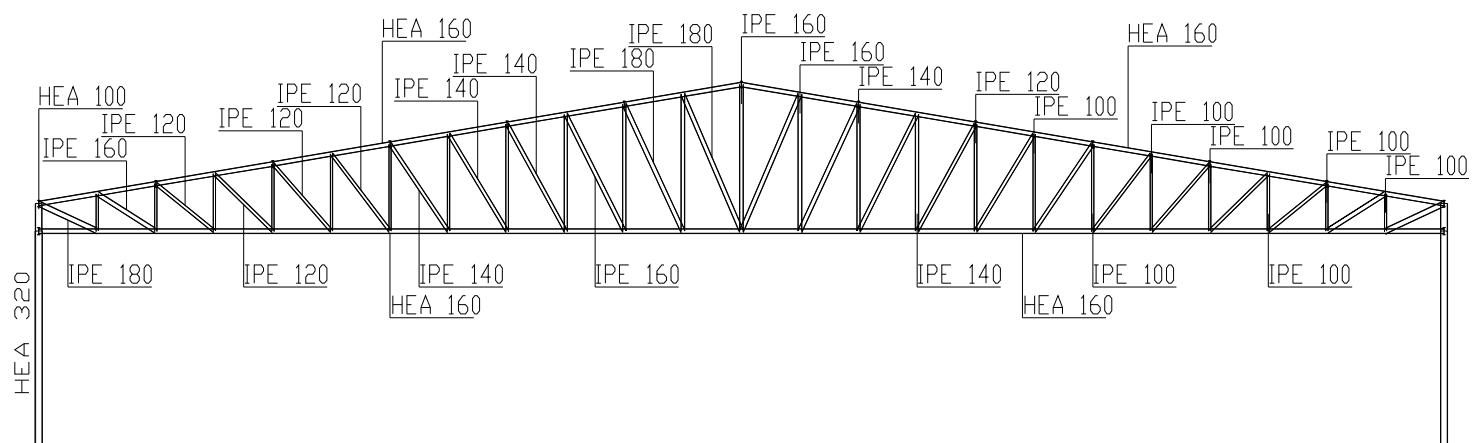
Pórtico com pilar de alma cheia, viga em treliça, vão de 60.00m, pilar em perfil com secção transversal HEA, viga em perfil com secção transversal HEA/IPE.
